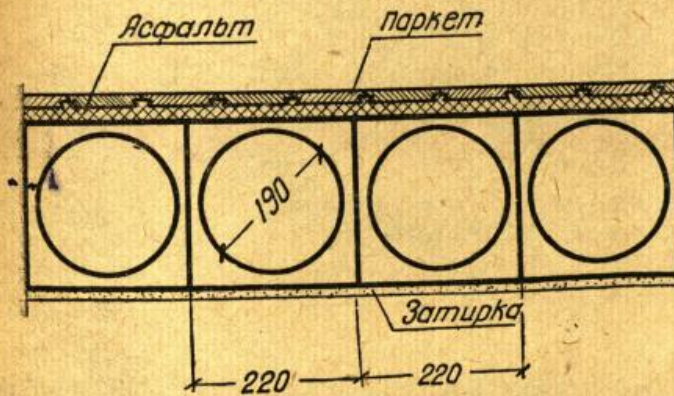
Сборное перекрытие из полых силикалитных балок.
